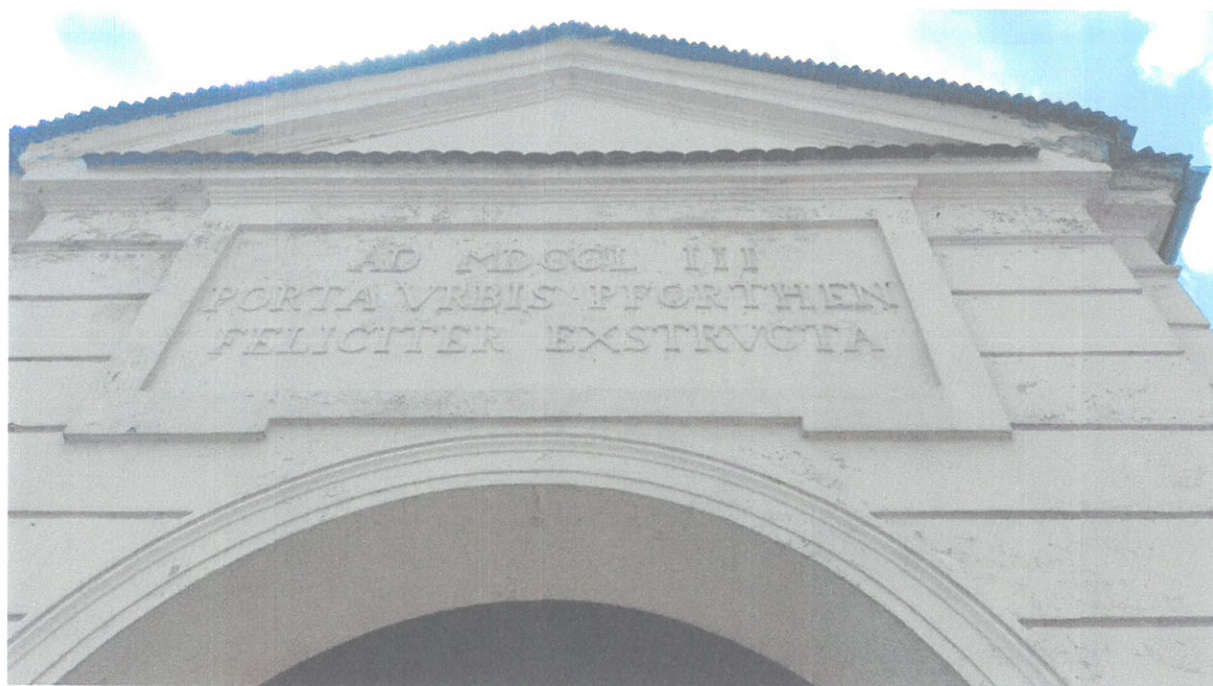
Widok elewacji południowej – detal architektoniczny nad bramą wejściową.
